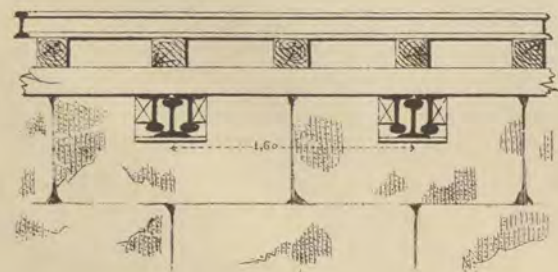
º Seccion y disposicion de las vigas formadas con carriles.
